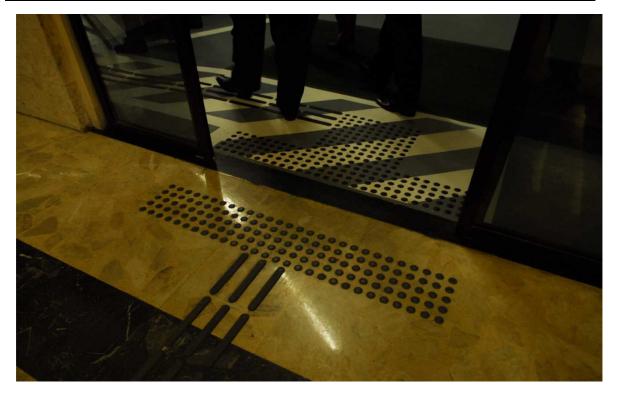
Vista da sinalização tátil de piso junto a uma porta de entrada da edificação, através do estacionamento de veículos.
